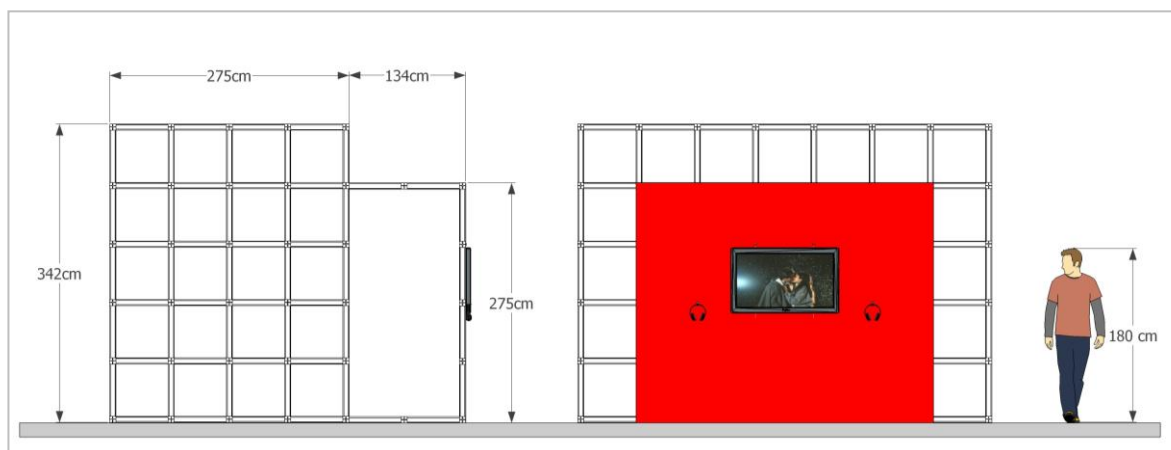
Elemento 13: cabine de projeção. Fonte: Autor.
